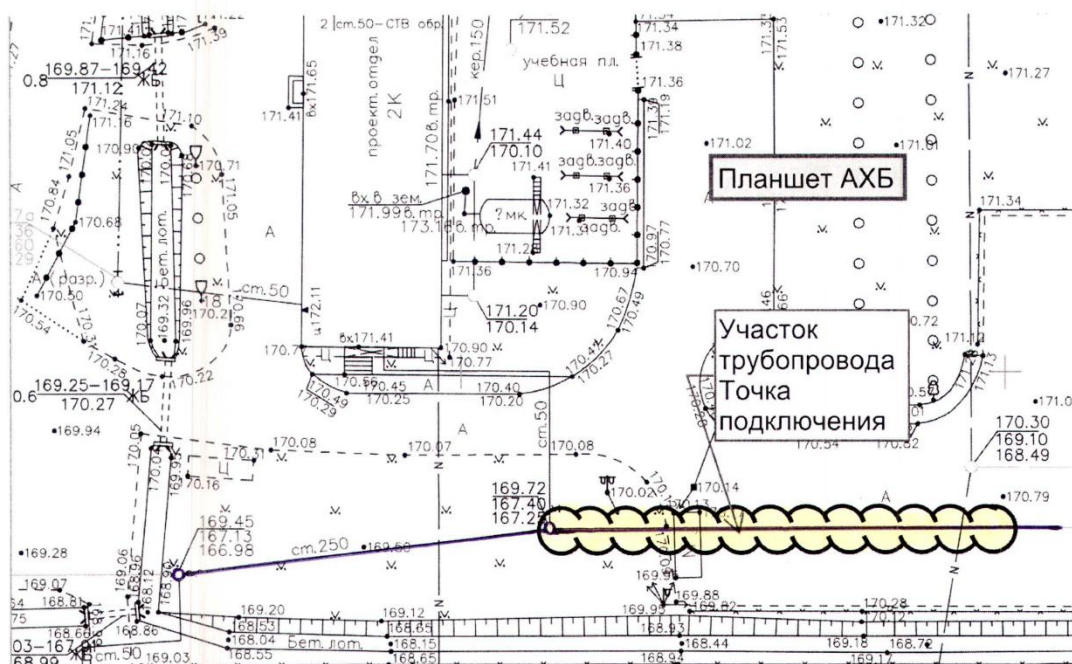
Схема подключения к сети ХПВ на планшете АХБ.
